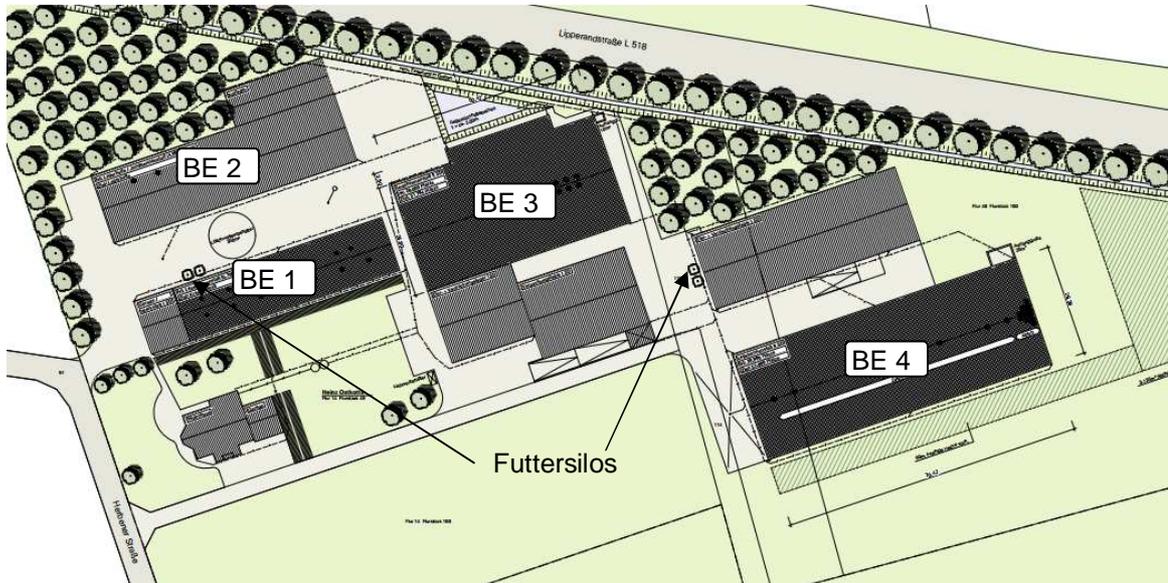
Lageplan mit Angabe der geplanten Maßnahmen (ohne Maßstab)
